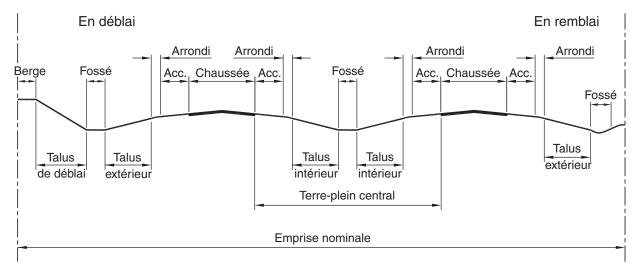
Éléments d'une route à chaussée séparée, coupe transversale
